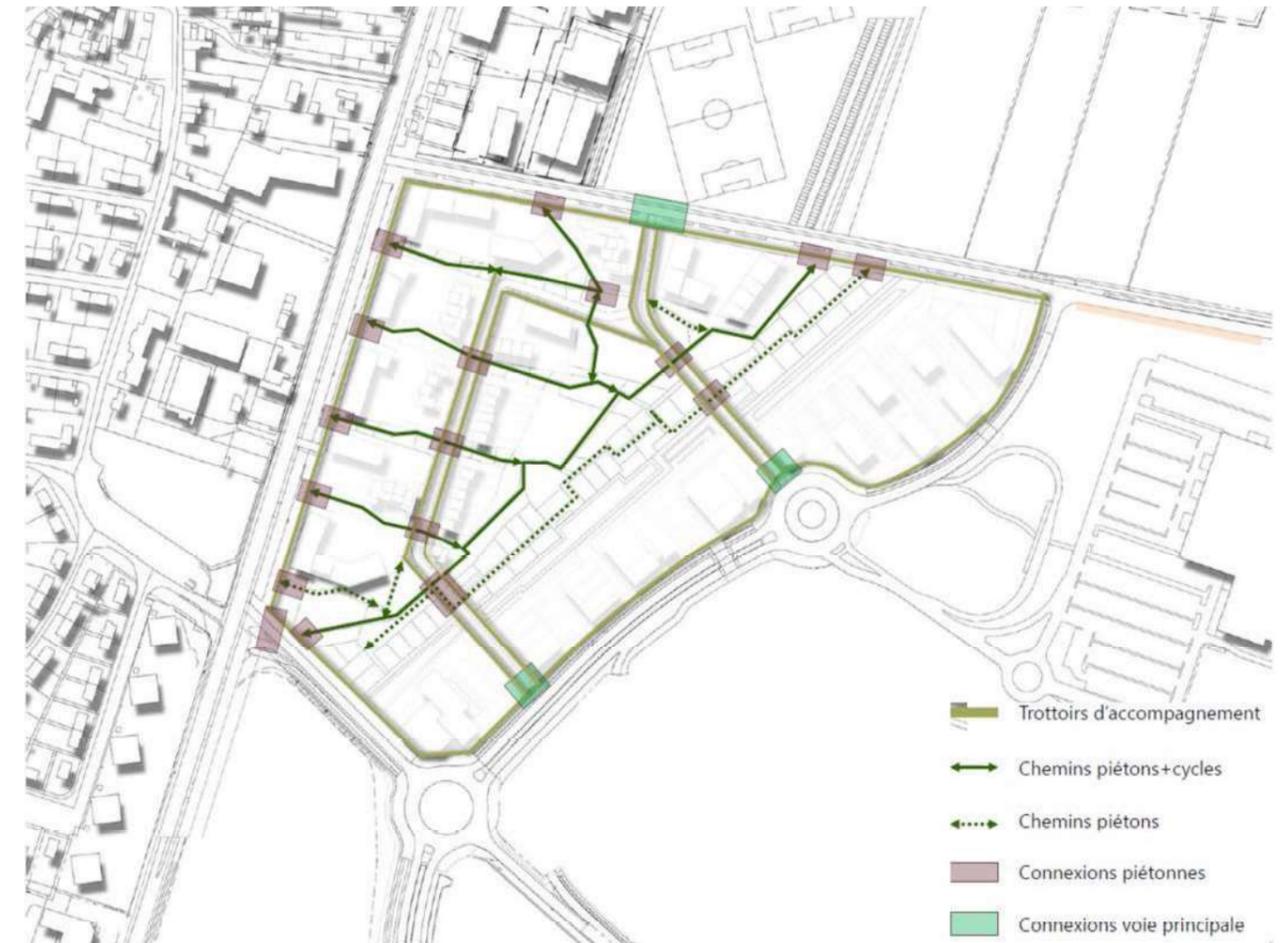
Plan des voies modes doux de déplacement (SEDELKA)
